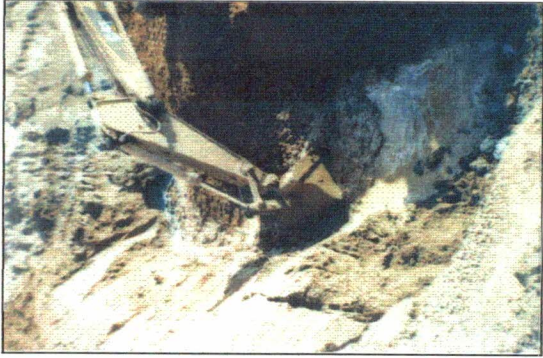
Detalhe da escavação final do cut-off (est. 42).
